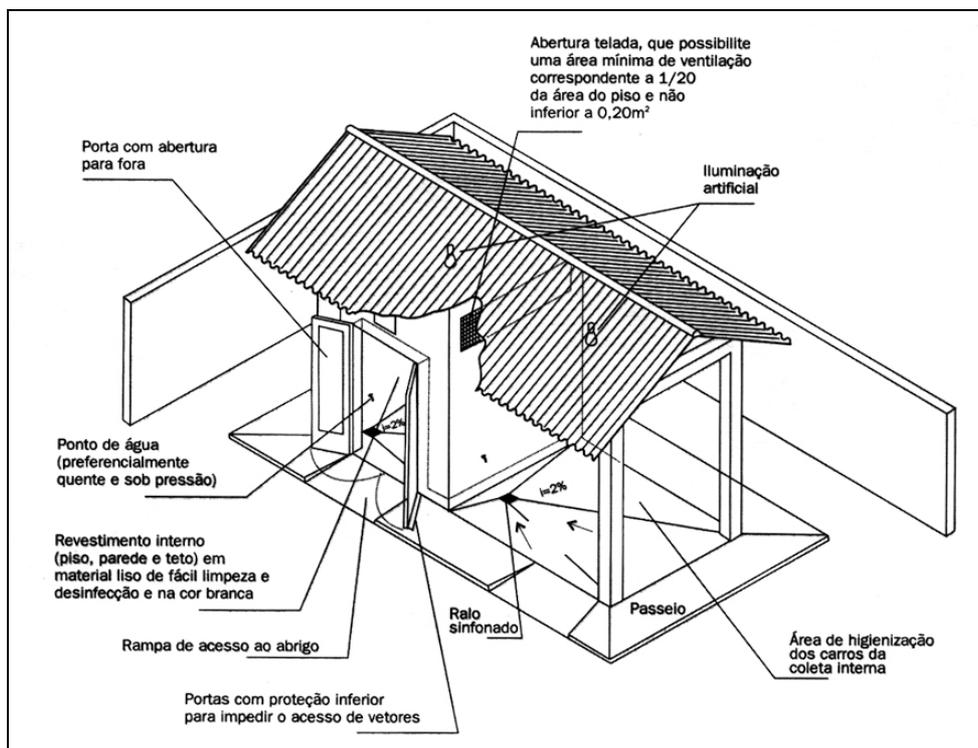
Recomendação técnica de construção de área de disposição externa.
